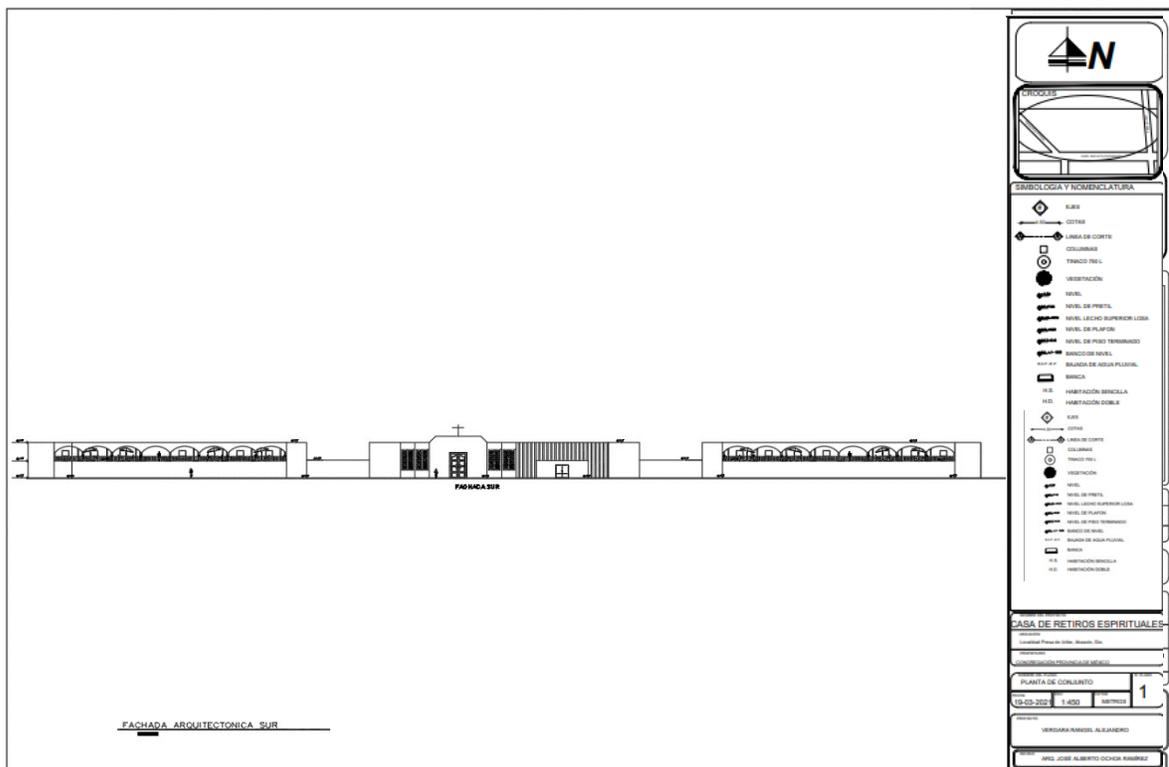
Anteproyecto. Fachada arquitectónica sur. (Fuente propia, 2021)
